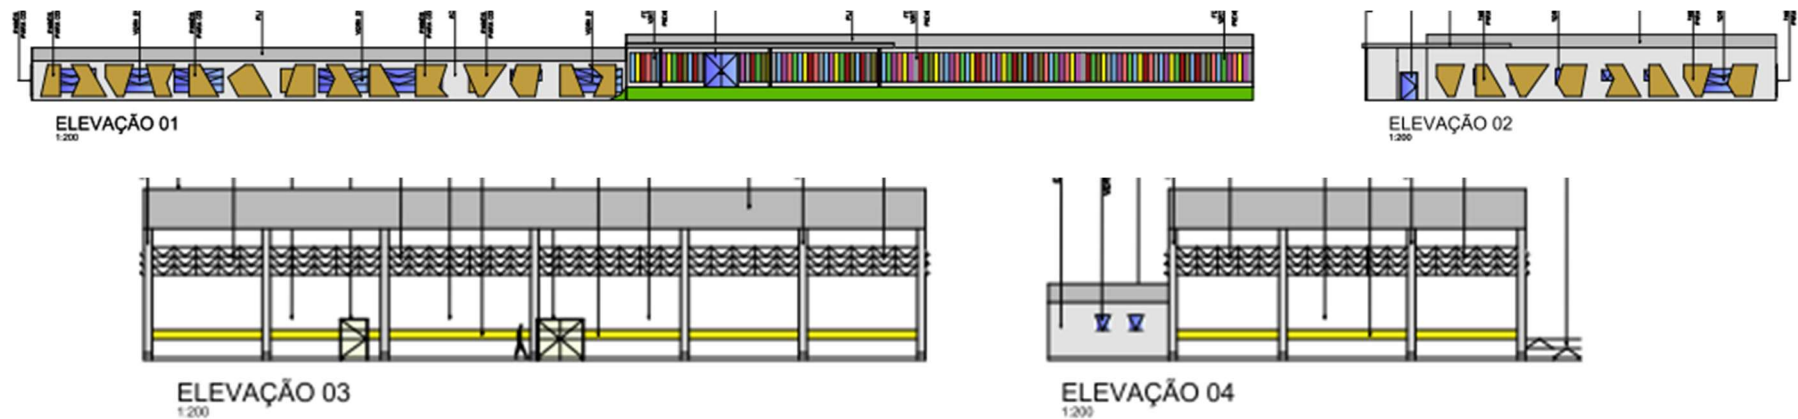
Imagem da fachada com brises verticais e painéis em aço cortén.
